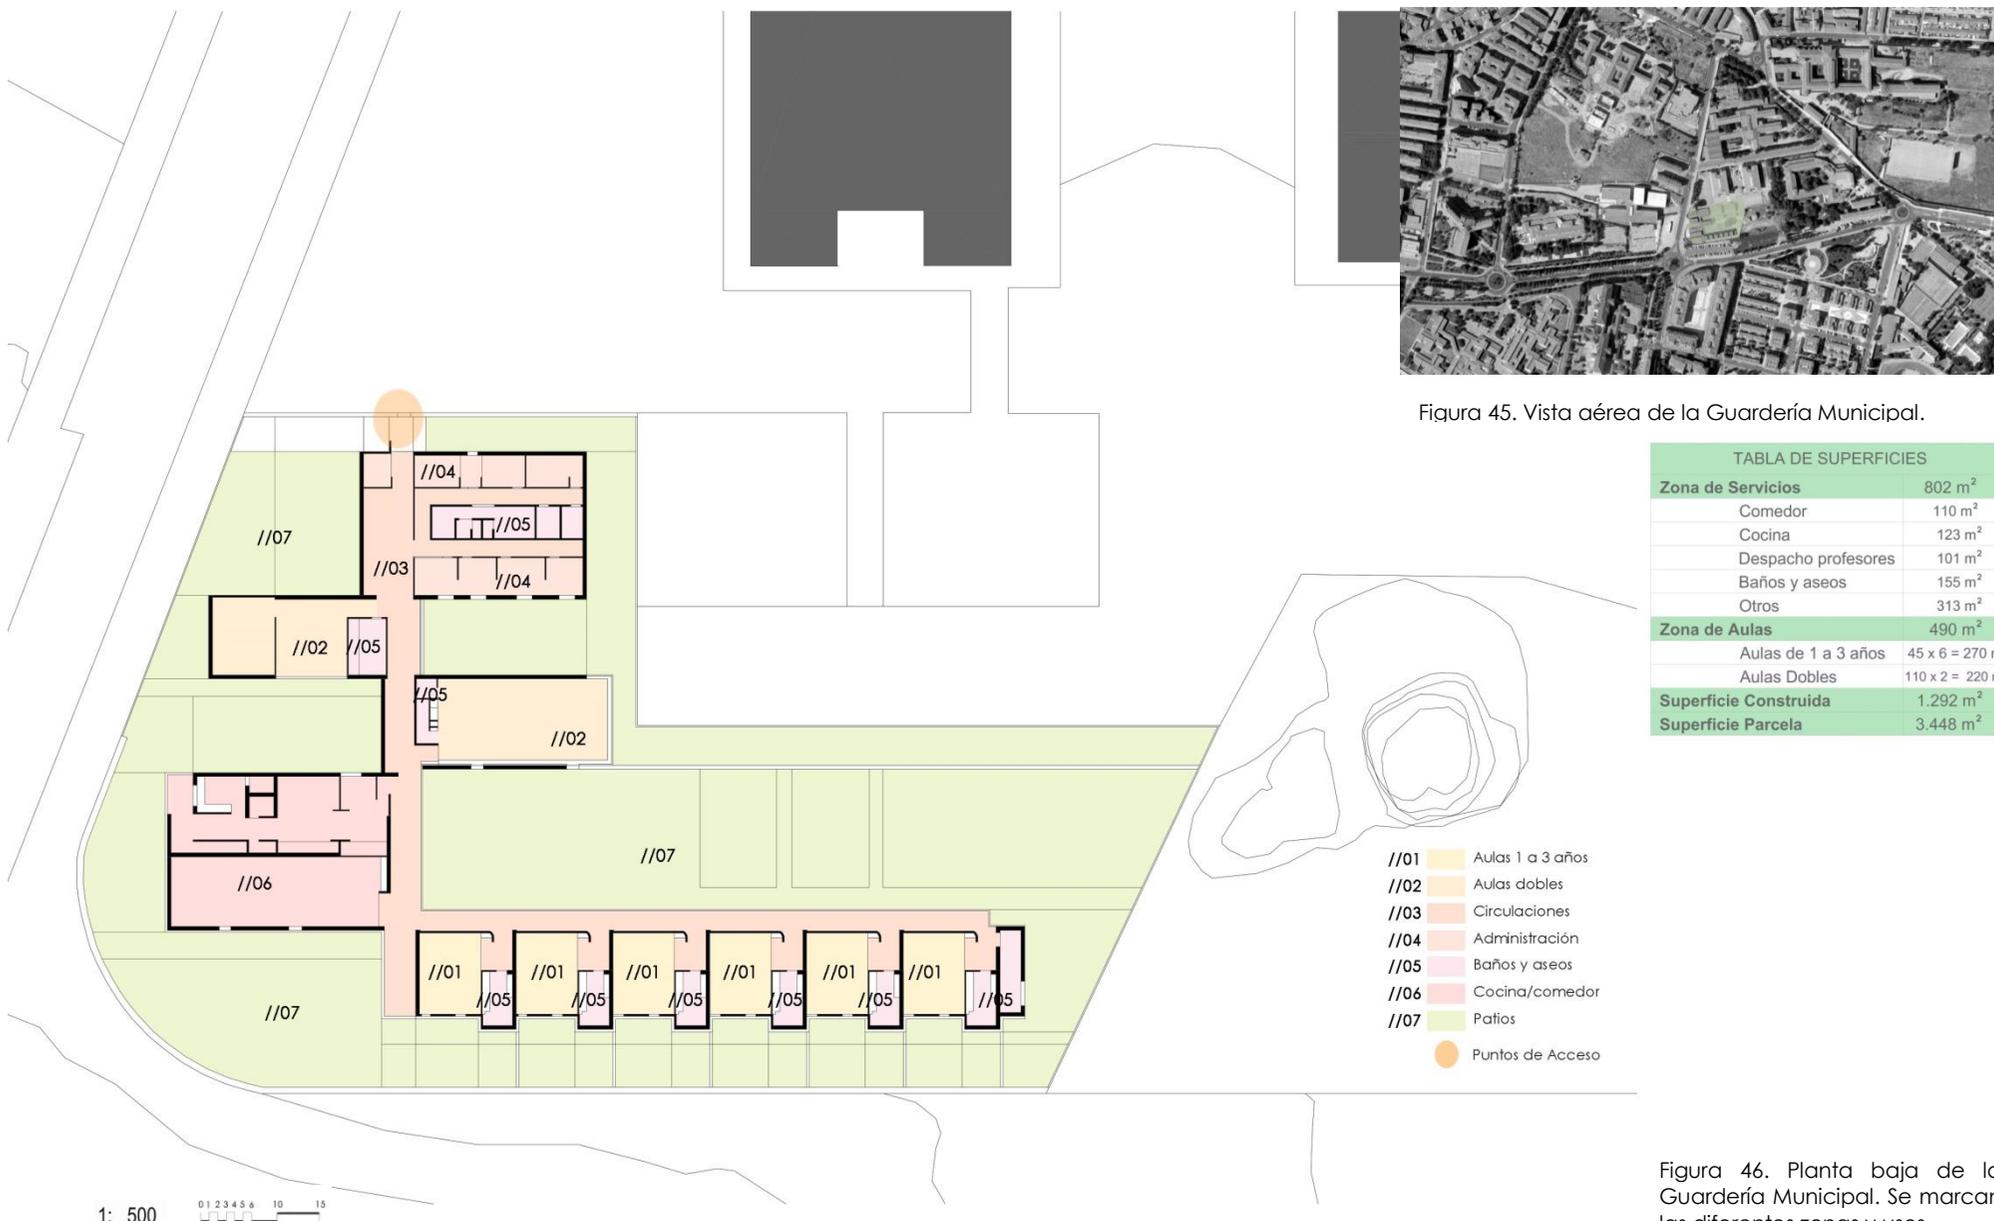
Planta baja de la Guardería Municipal. Se marcan las diferentes zonas y usos.
